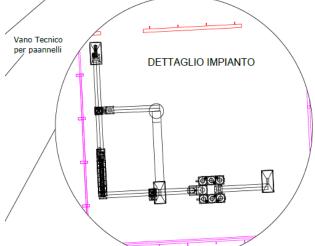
Dettaglio stralcio "Planimetria Generale con intervento".
